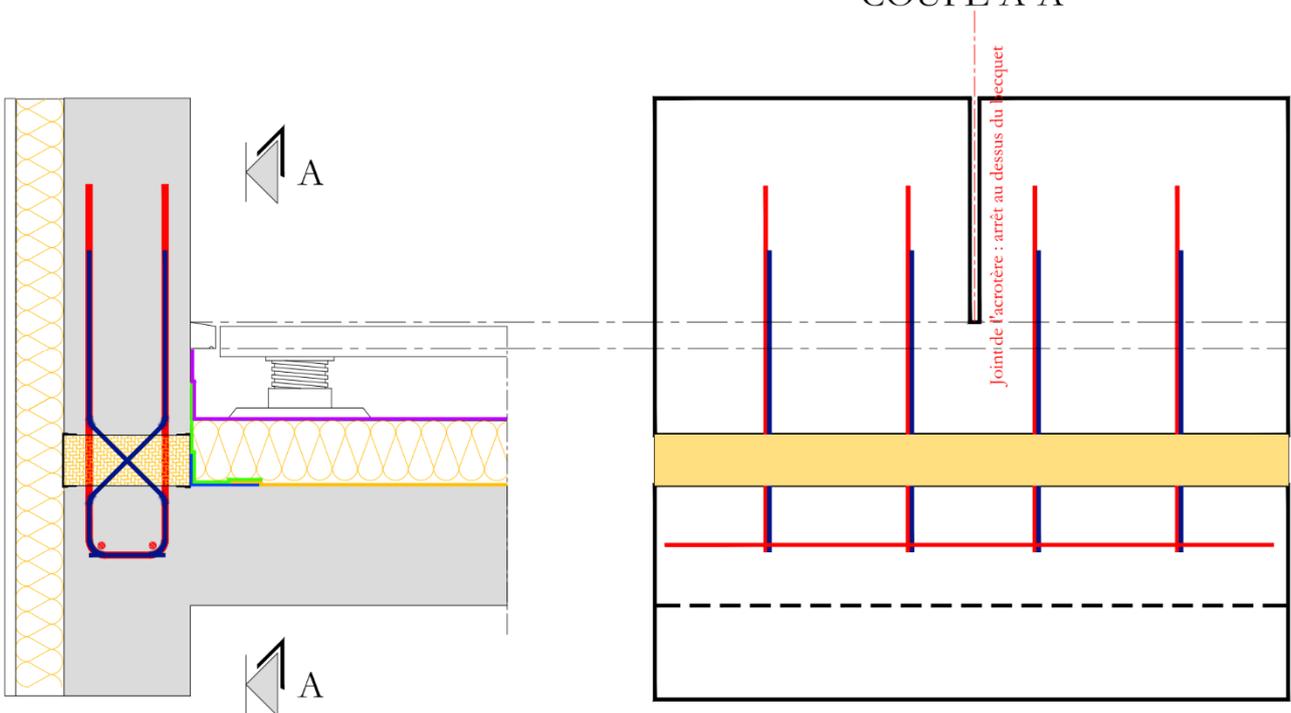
Positionnement sur toiture-terrace étanchée avec dalle sur plots conforme au CPT 3794 de février 2018, avec détail de l'arrêt du joint de l'acrotère
